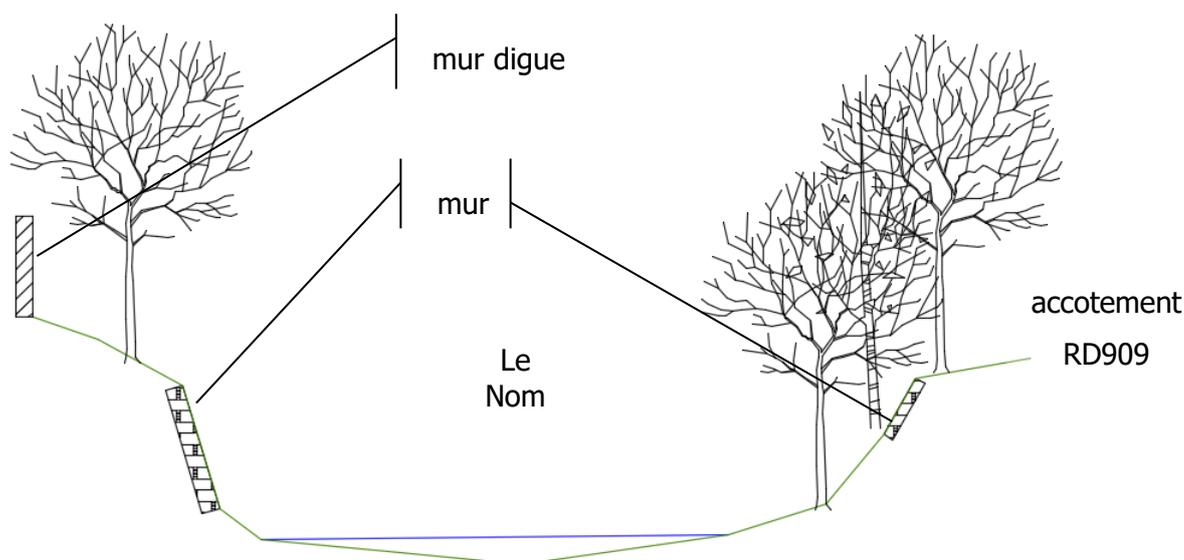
Section type du lit mineur du Nom au droit du site d'étude
